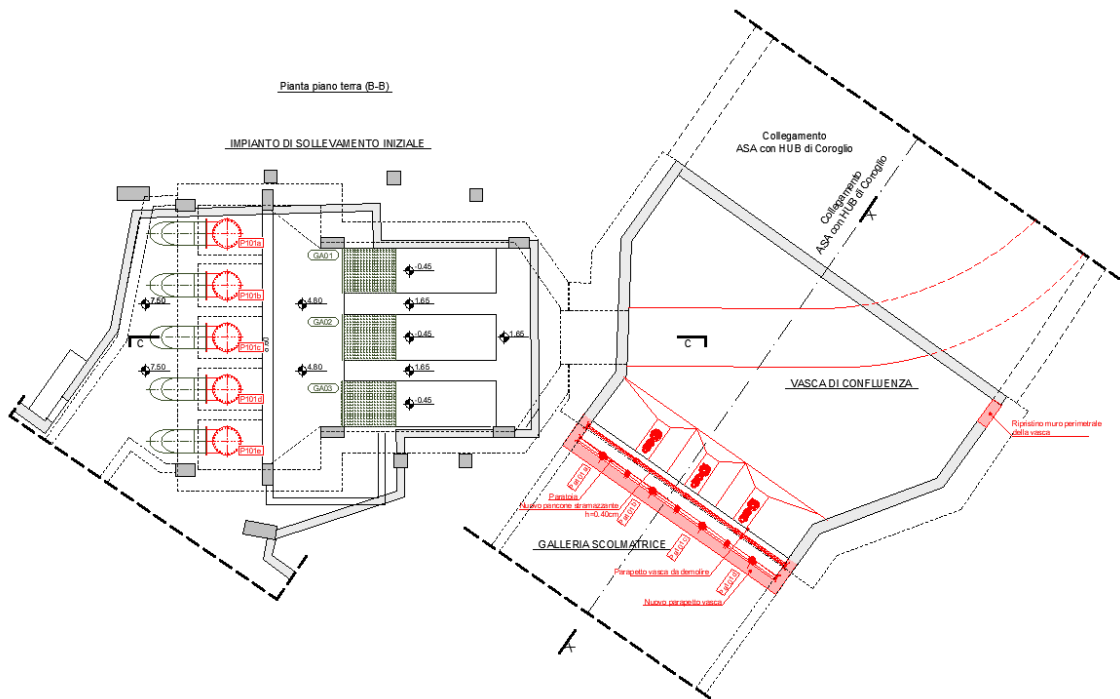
Sollevamento iniziale – Stato di progetto – Pianta piano terra
